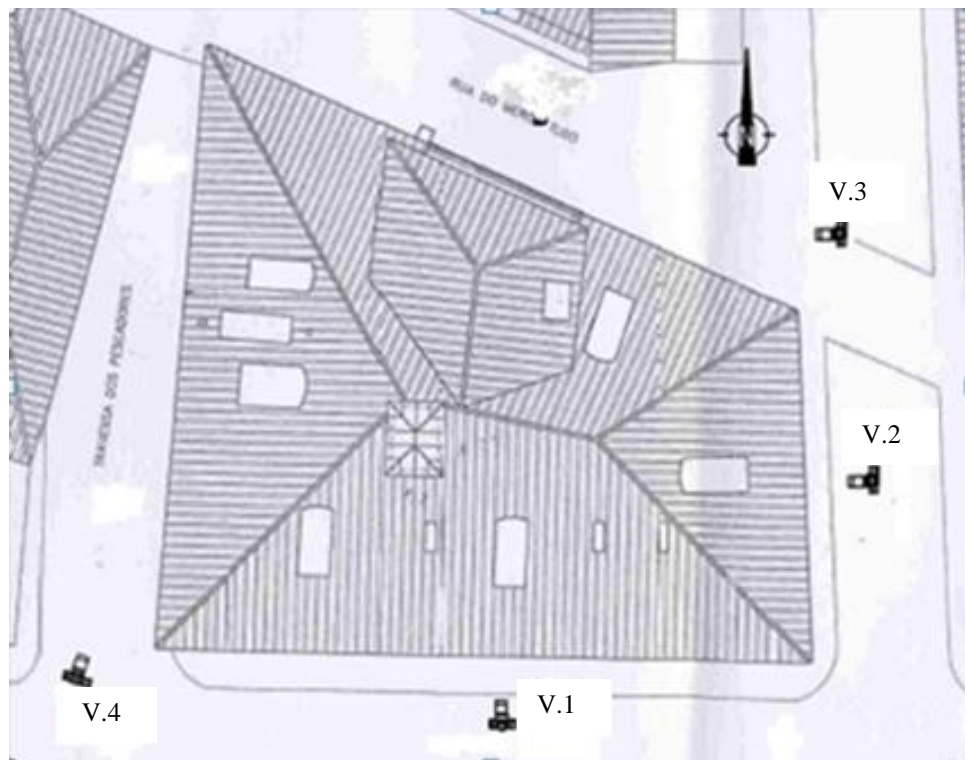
Planta da cobertura do edifício estudo de caso [77]
